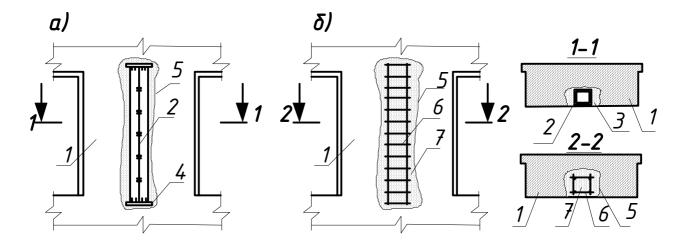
Усиление каменных простенков устройством несущего сердечника: а – стального из двух сваренных швеллеров; б – железобетонного; 1- усиливаемый простенок; 2 – стальной сердечник; 3 – цементно- песчаный раствор; 4 – опорные пластины стального сердечника; 5 – вертикальная ниша, пробитая в простенке; 6 – арматурный каркас; 7 – бетон.
